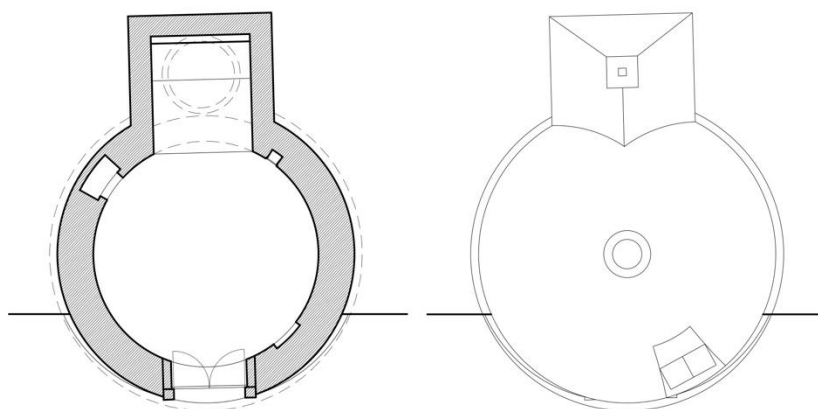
planta da capela, São Bartolomeu, Aveiro.
